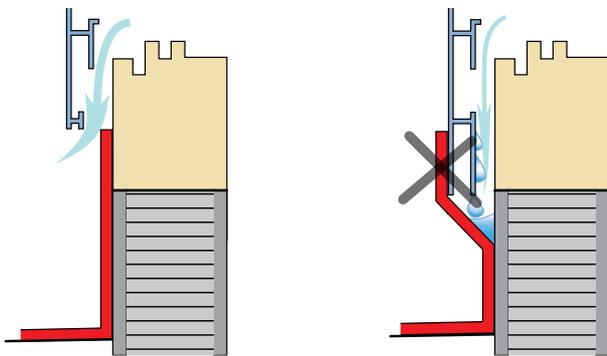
Les ventilations avec profils de recouvrement doivent rester ouvertes (à gauche), étanchéité (rouge)
